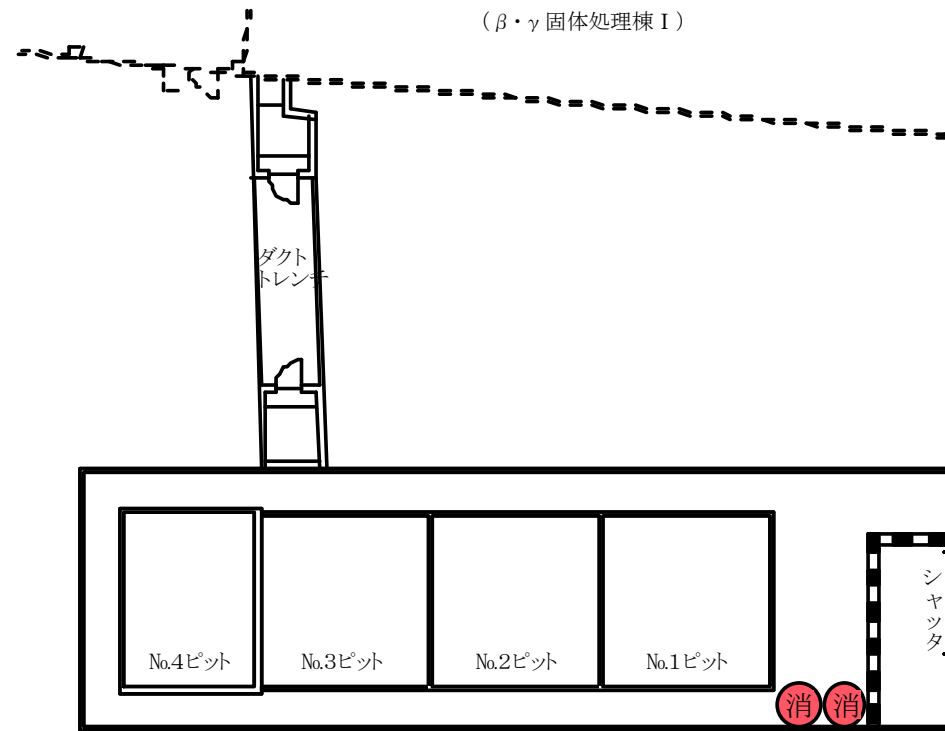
2 2 β ・ γ 一時格納庫 I 平面図
